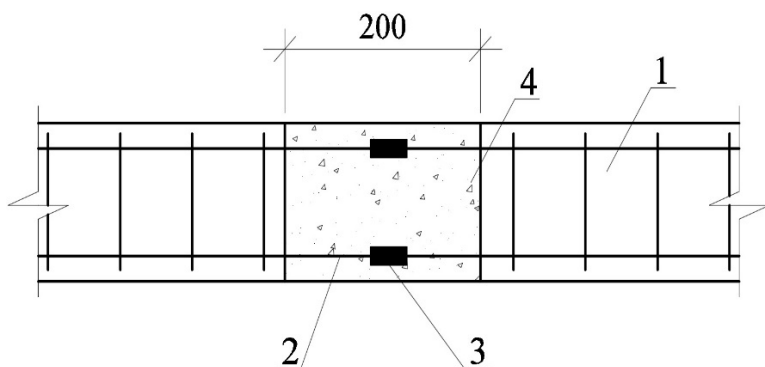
Сварной стык сборного антисейсмического пояса: 1 – сборные железобетонные элементы пояса; 2 – выпуски арматуры; 3 – сварные соединения; 4 – монолитный бетон
